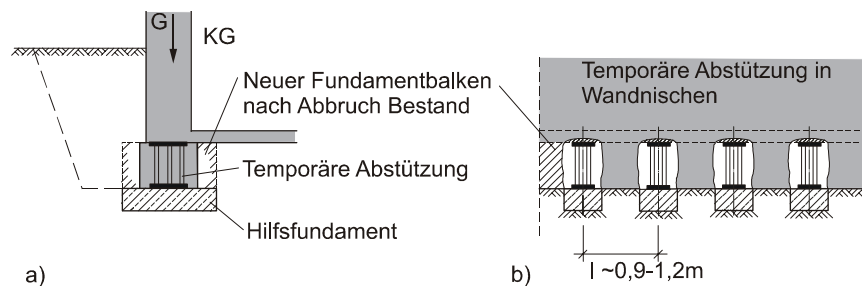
Nachträgliche Herstellung eines Stahlbetonbalkens mit durchgehender Bewehrung
